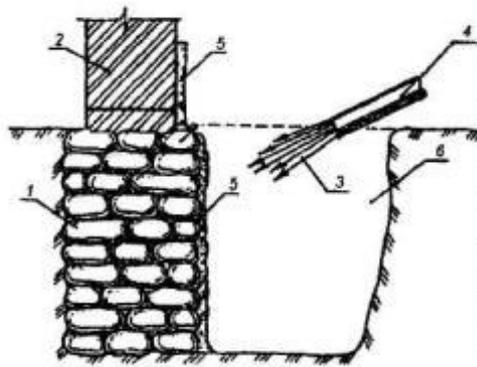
1 - существующий фундамент, имеющий расслоение кладки; 2 - кирпичная стена с разрушенным поверхностным слоем; 3 - набрызг бетонной смеси под высоким давлением; 4 - цемент-пушка (или бетон-шприц-машина); 5 - торкретируемая поверхность; 6 - шурф.
